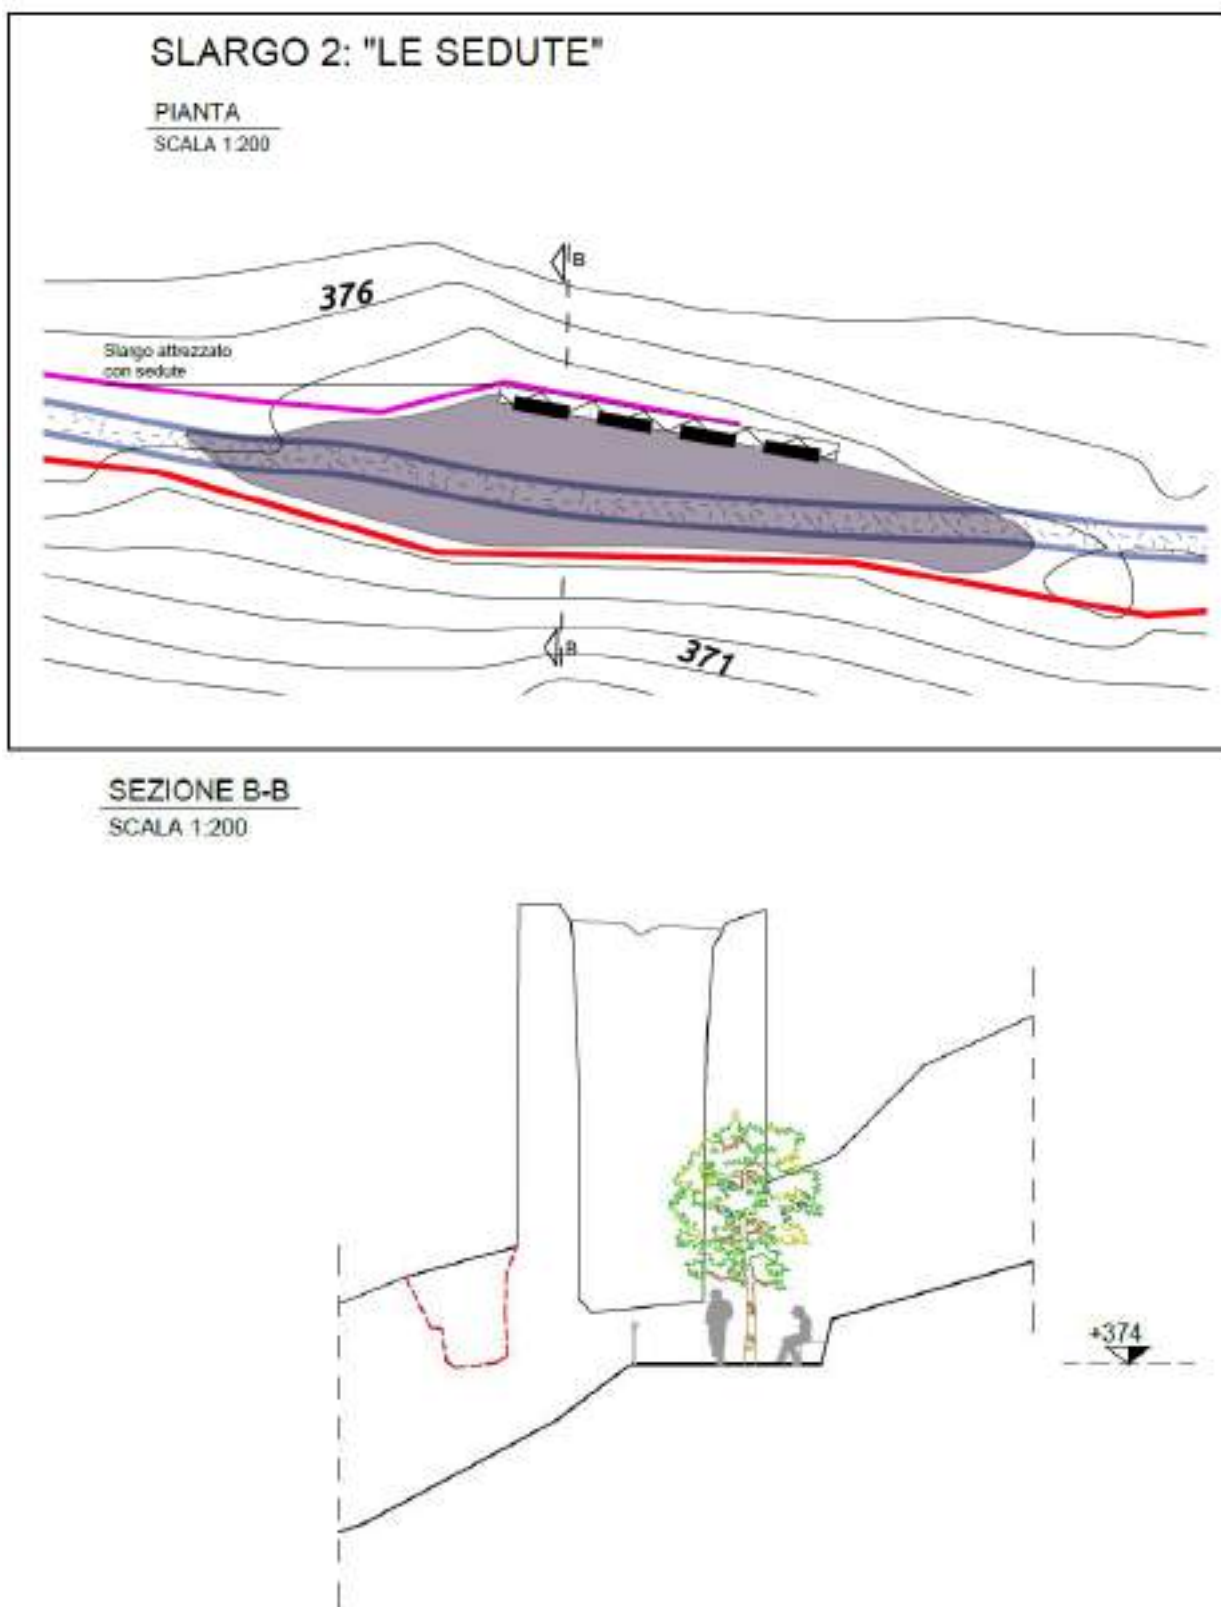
Planimetria e sezioni Slargo 2 "le sedute", in dettaglio la posizione della torre
